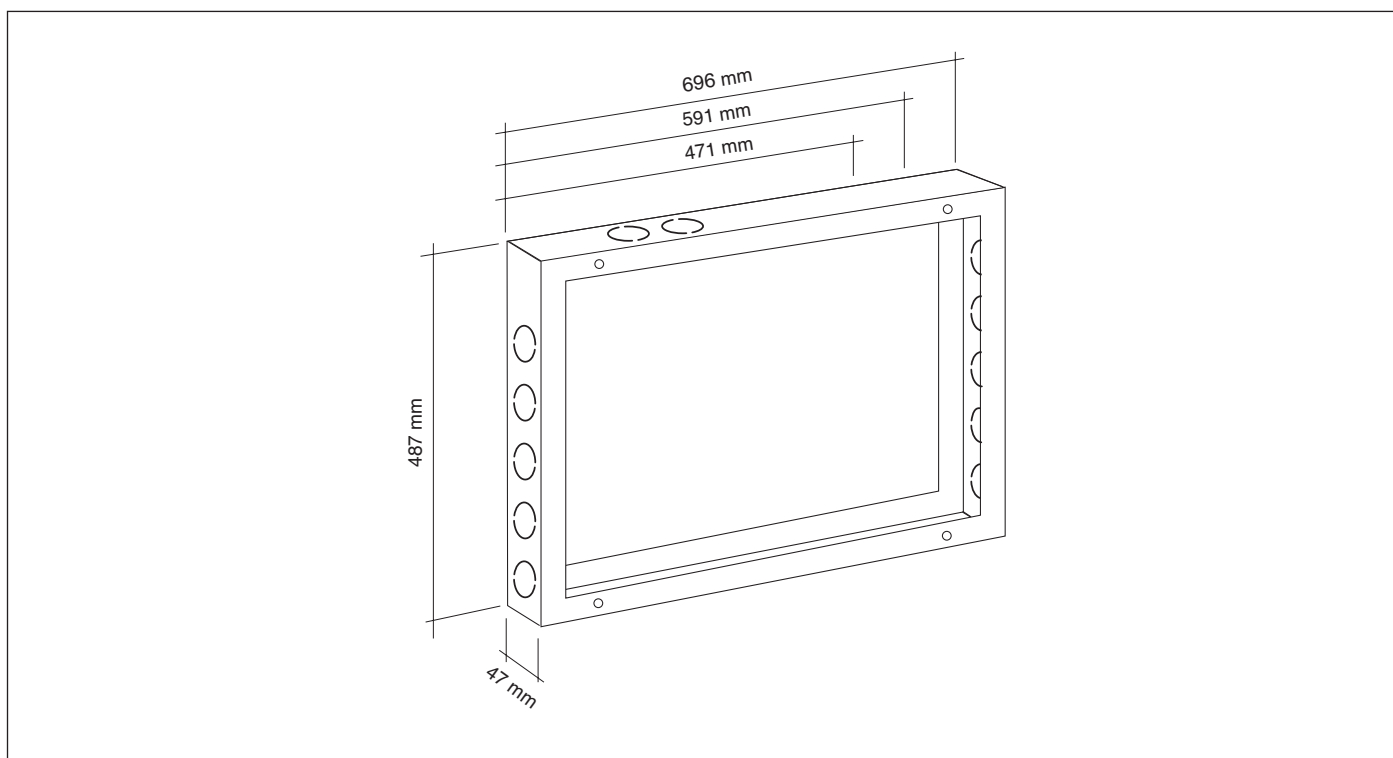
Contramarco para instalaciones con tuberías en paredes internas
